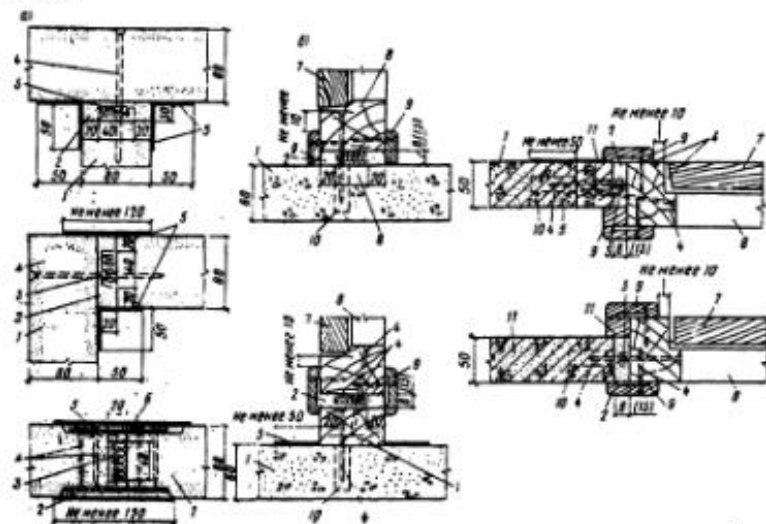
Перегородки из гипсобетонных панелей и узлы их крепления к несущим конструкциям: а - вариант перегородки из однослойных прокатных панелей; б - то же, из двух прокатных гипсобетонных панелей с воздушным зазором; в - крепление перегородки по ее высоте к ригелю; г - крепление перегородки в плане к колонне; 1 - панель междуэтажного перекрытия; 2 - стена; 3 - дверной блок; 4 - гипсобетонная панель; 5,13, 16 - скоба; 6 - гвозди; 7 - прослойка тканью; 8 - конюпатка паклей, пропитанной гипсовым раствором; 9 - анкер; 10 - заделка гипсовым раствором; 11 - один слой рубероида; 12 - цементный раствор; 14 - деревянный антисептированный брусок 40x40 мм; 15 - железобетонный ригель; 17 - деревянный антисептированный брусок 40x60 мм; 18 - железобетонная колонна.
